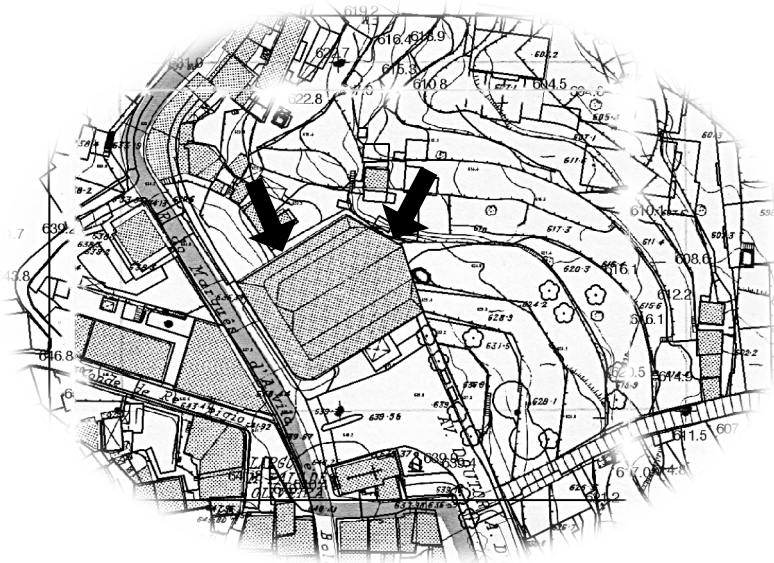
O problema das fachadas - sobreposição do ficheiro CAD a uma planta do terreno.
